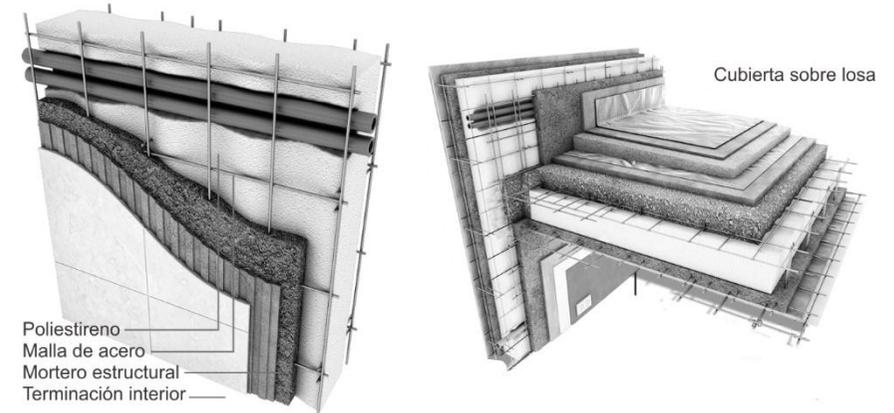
Detalle de instalaciones y cubierta de techo en paneles de concreto proyectado, del sitio de "Casaforma"
